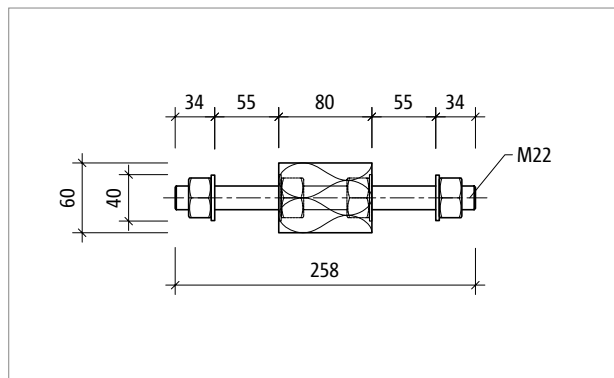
Schöck Isokorb® T type S-N-D22 : coupe du produit
